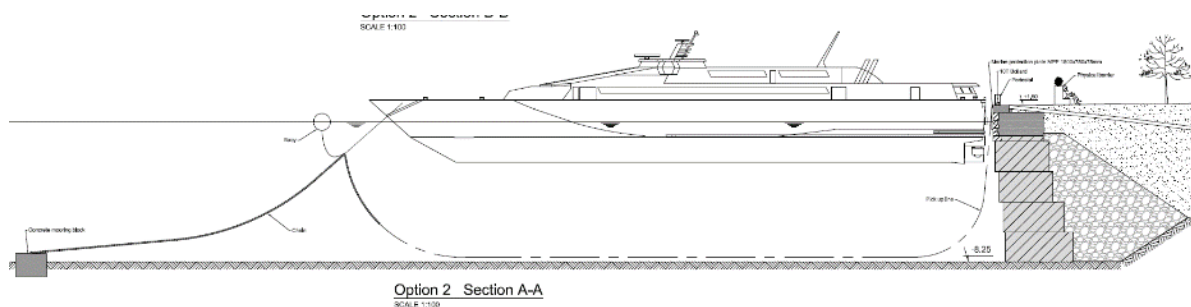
Примерен надлъжен разрез на понтонна конструкция
